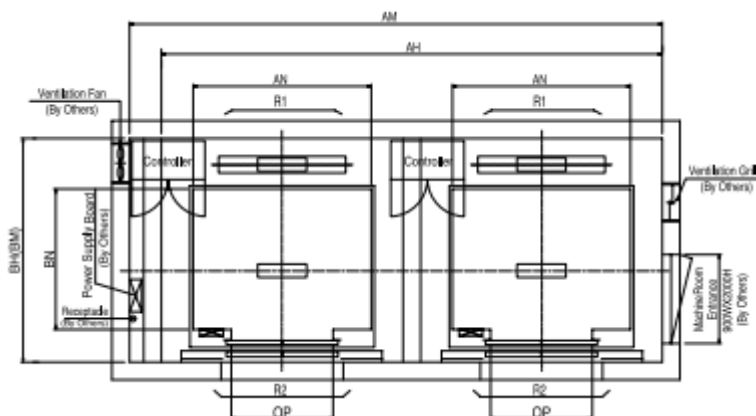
Denah Pembalokan pada Ruang Lift
